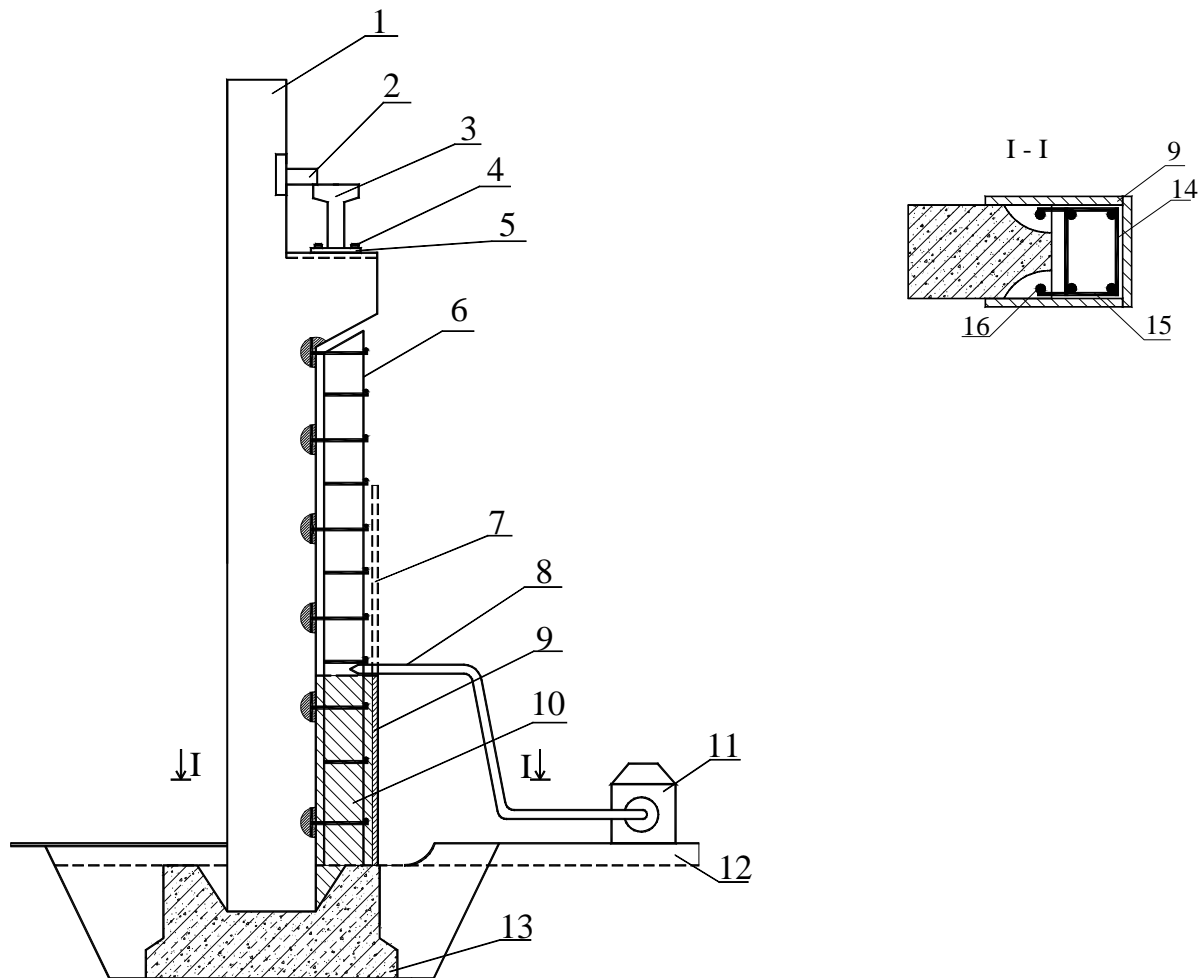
Схема організації робіт з підсилення консолі залізобетонної колони бетонуванням:
